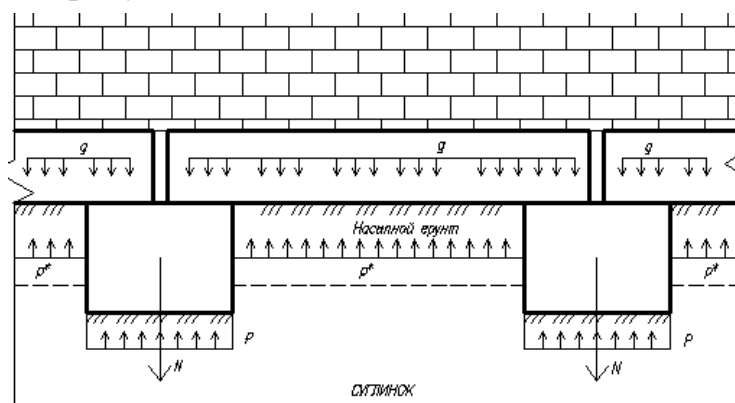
Фактическая схема передачи нагрузки на основание
